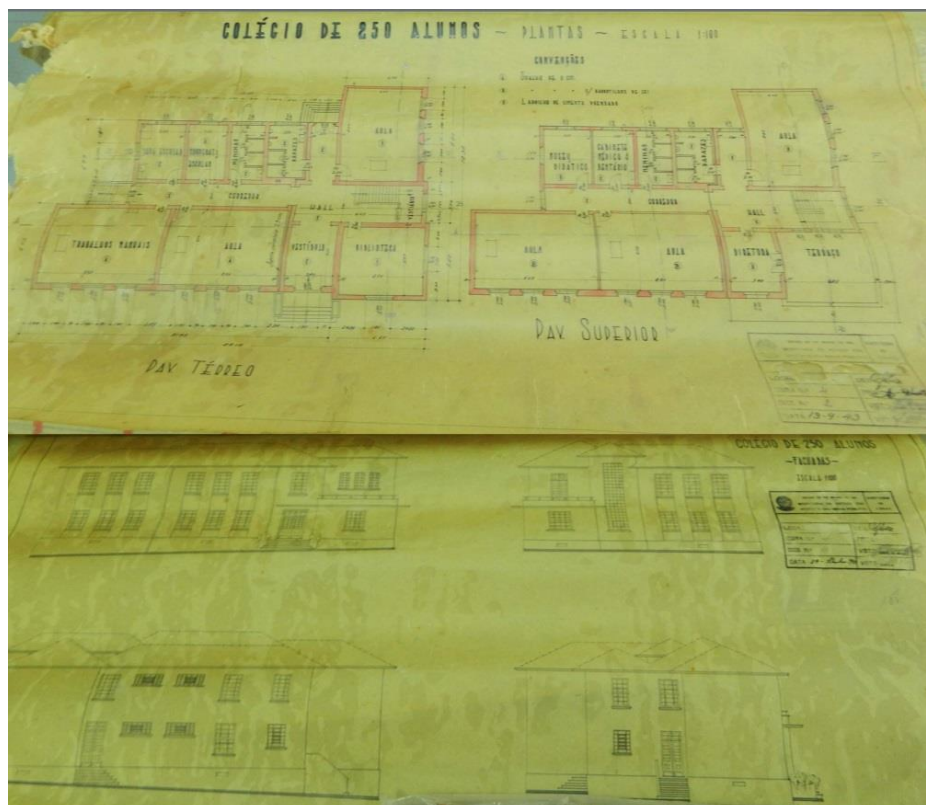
Plantas de 1º e 2º pavimentos e fachadas de Colégio para 250 alunos.
